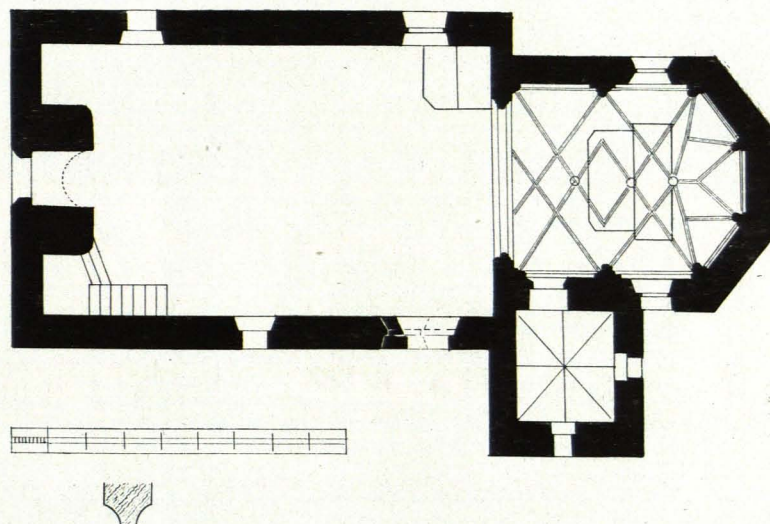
Kirchberg. Filialkirche, Grundriß 1:200 (S. 265)
